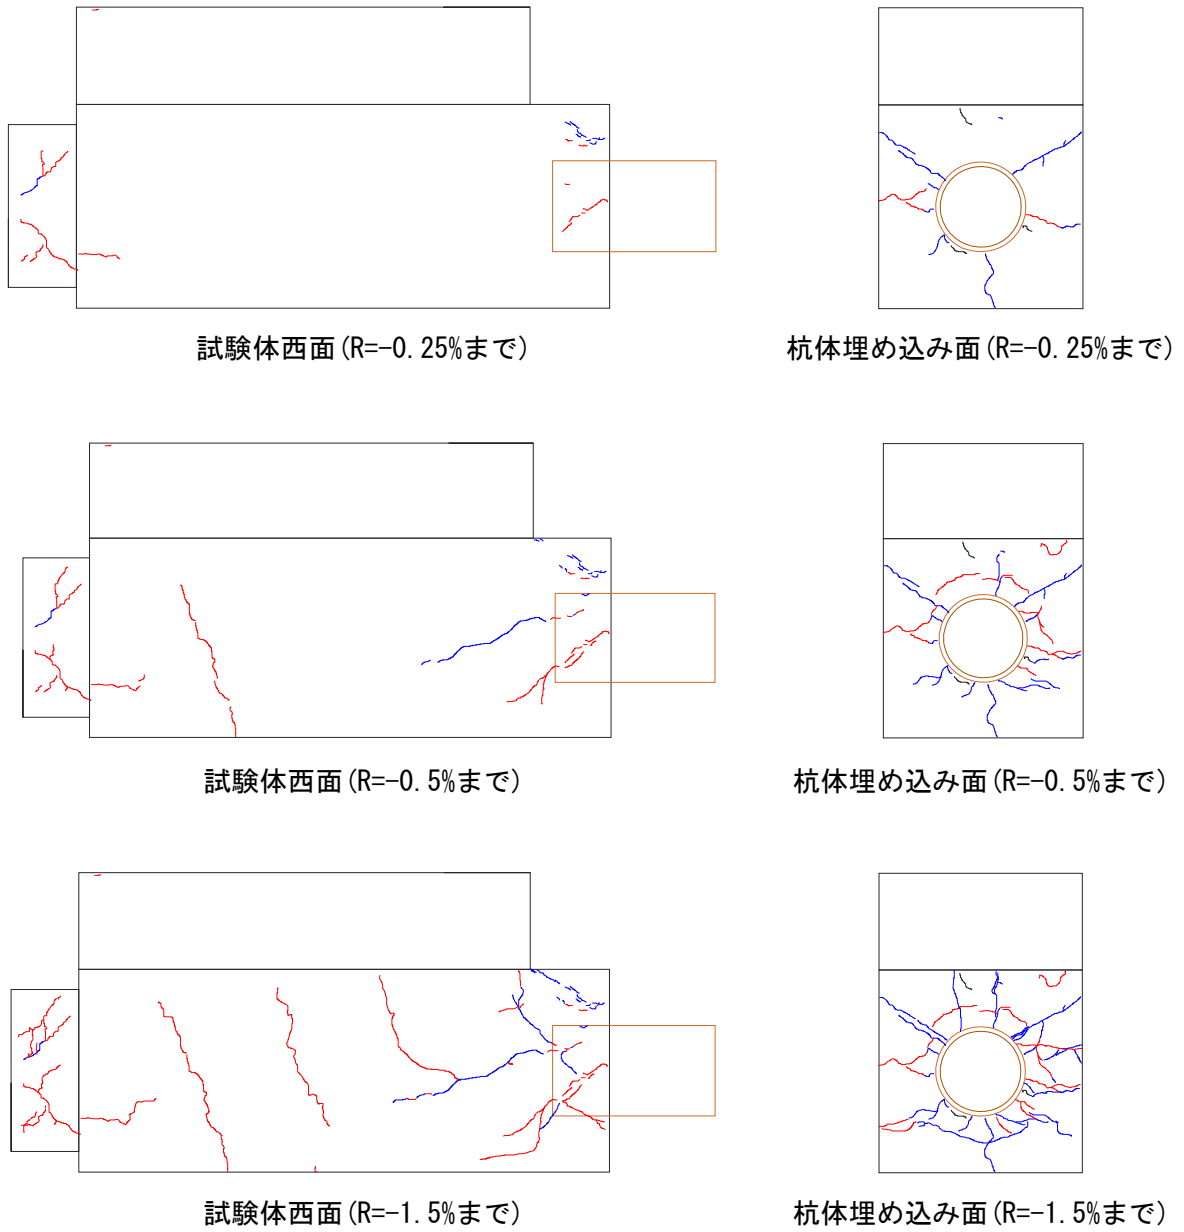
試験体 No. 1 のひび割れ進展状況
